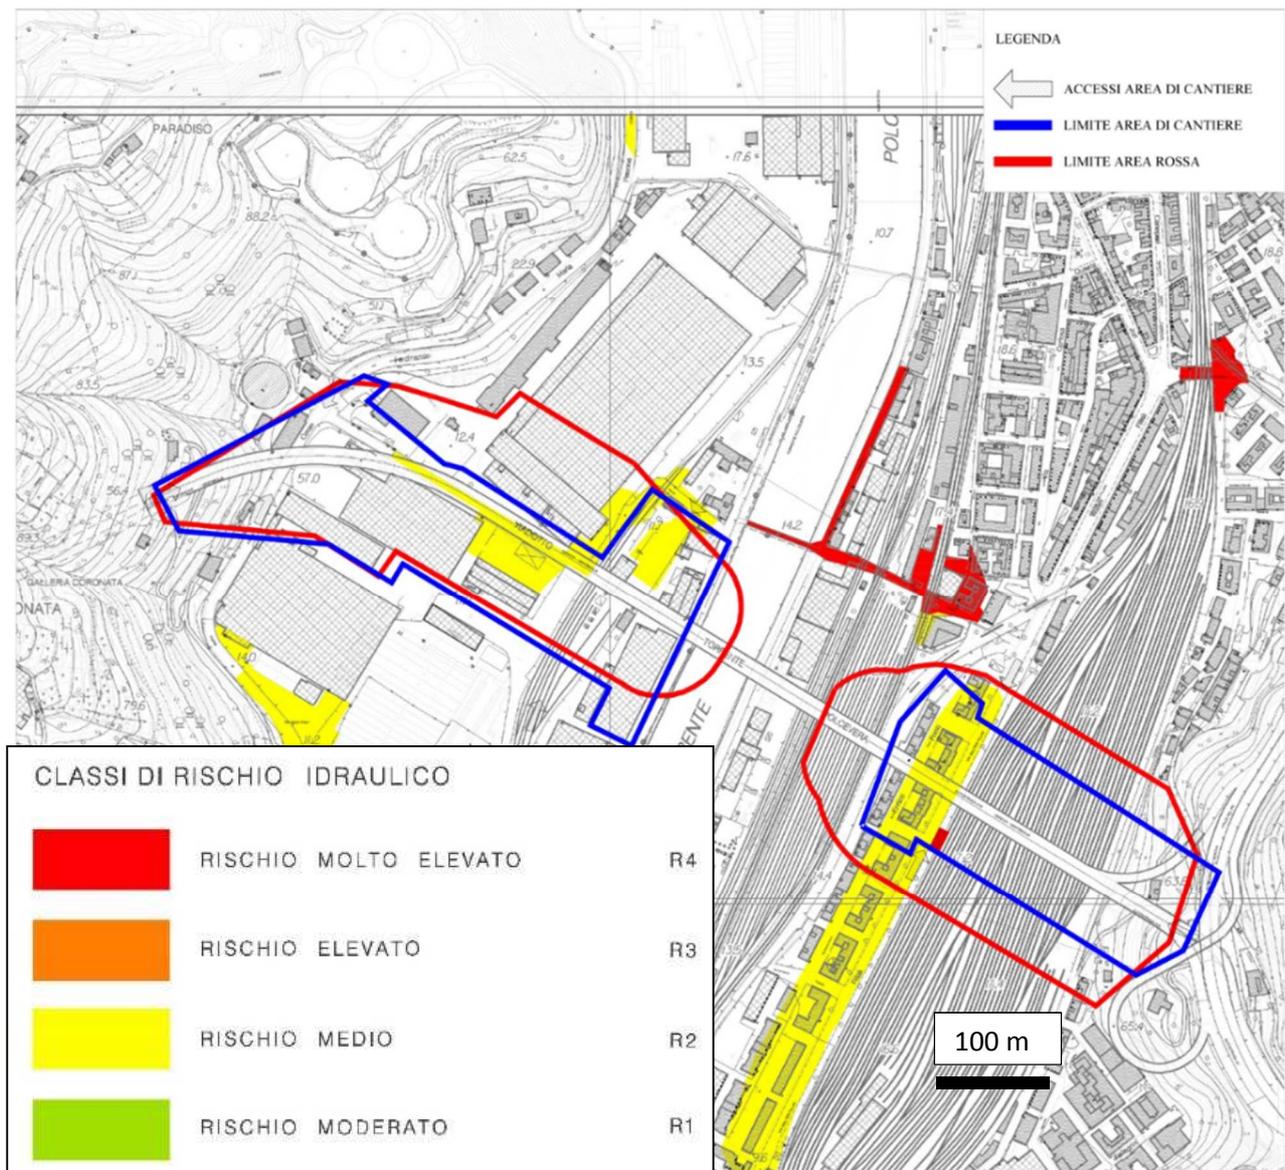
Estratto PdB Polcevera Sovrapposizione planimetria area di cantiere con Carta del Rischio idraulico
